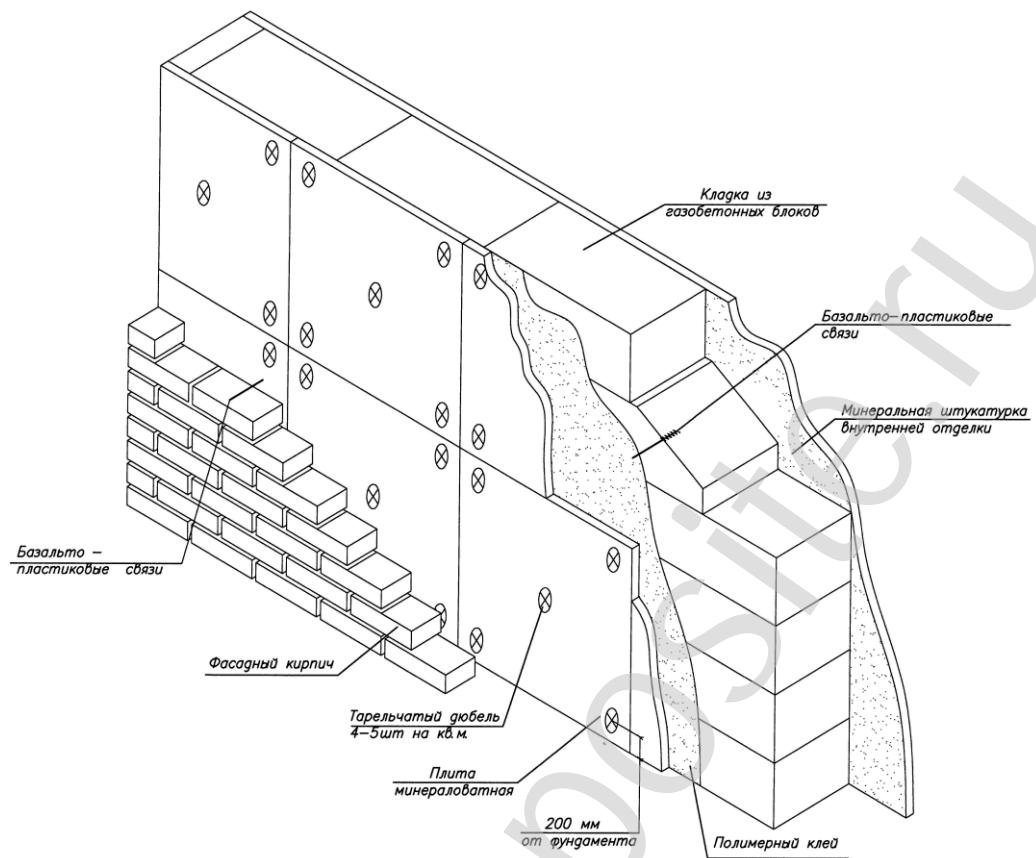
Конструкция стены, состоящей из газобетонных блоков, утеплителя и облицовочного кирпича
